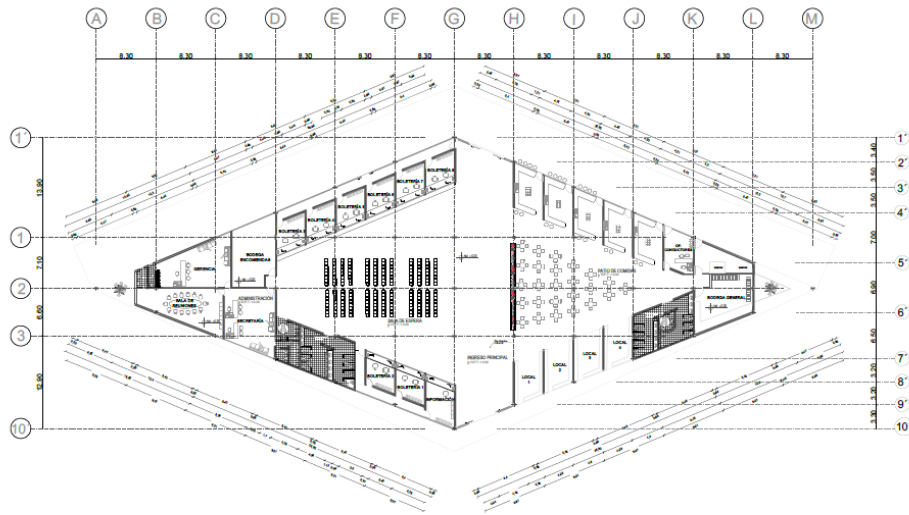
Planta general Propuesta terminal terrestre Pujilí
